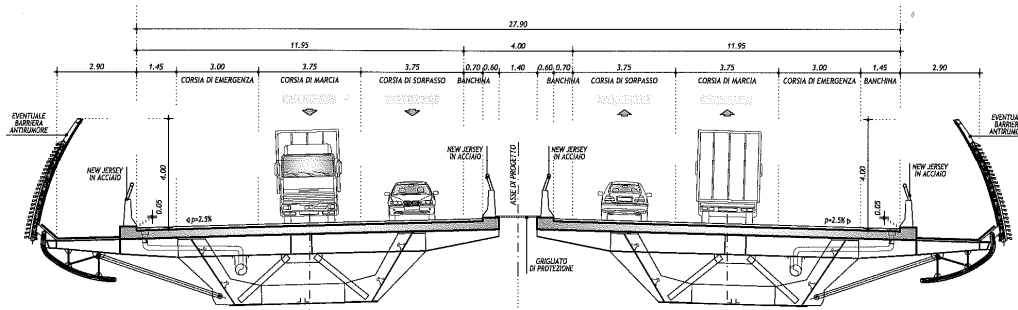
SEZIONE TIPO SU VIADOTTO
